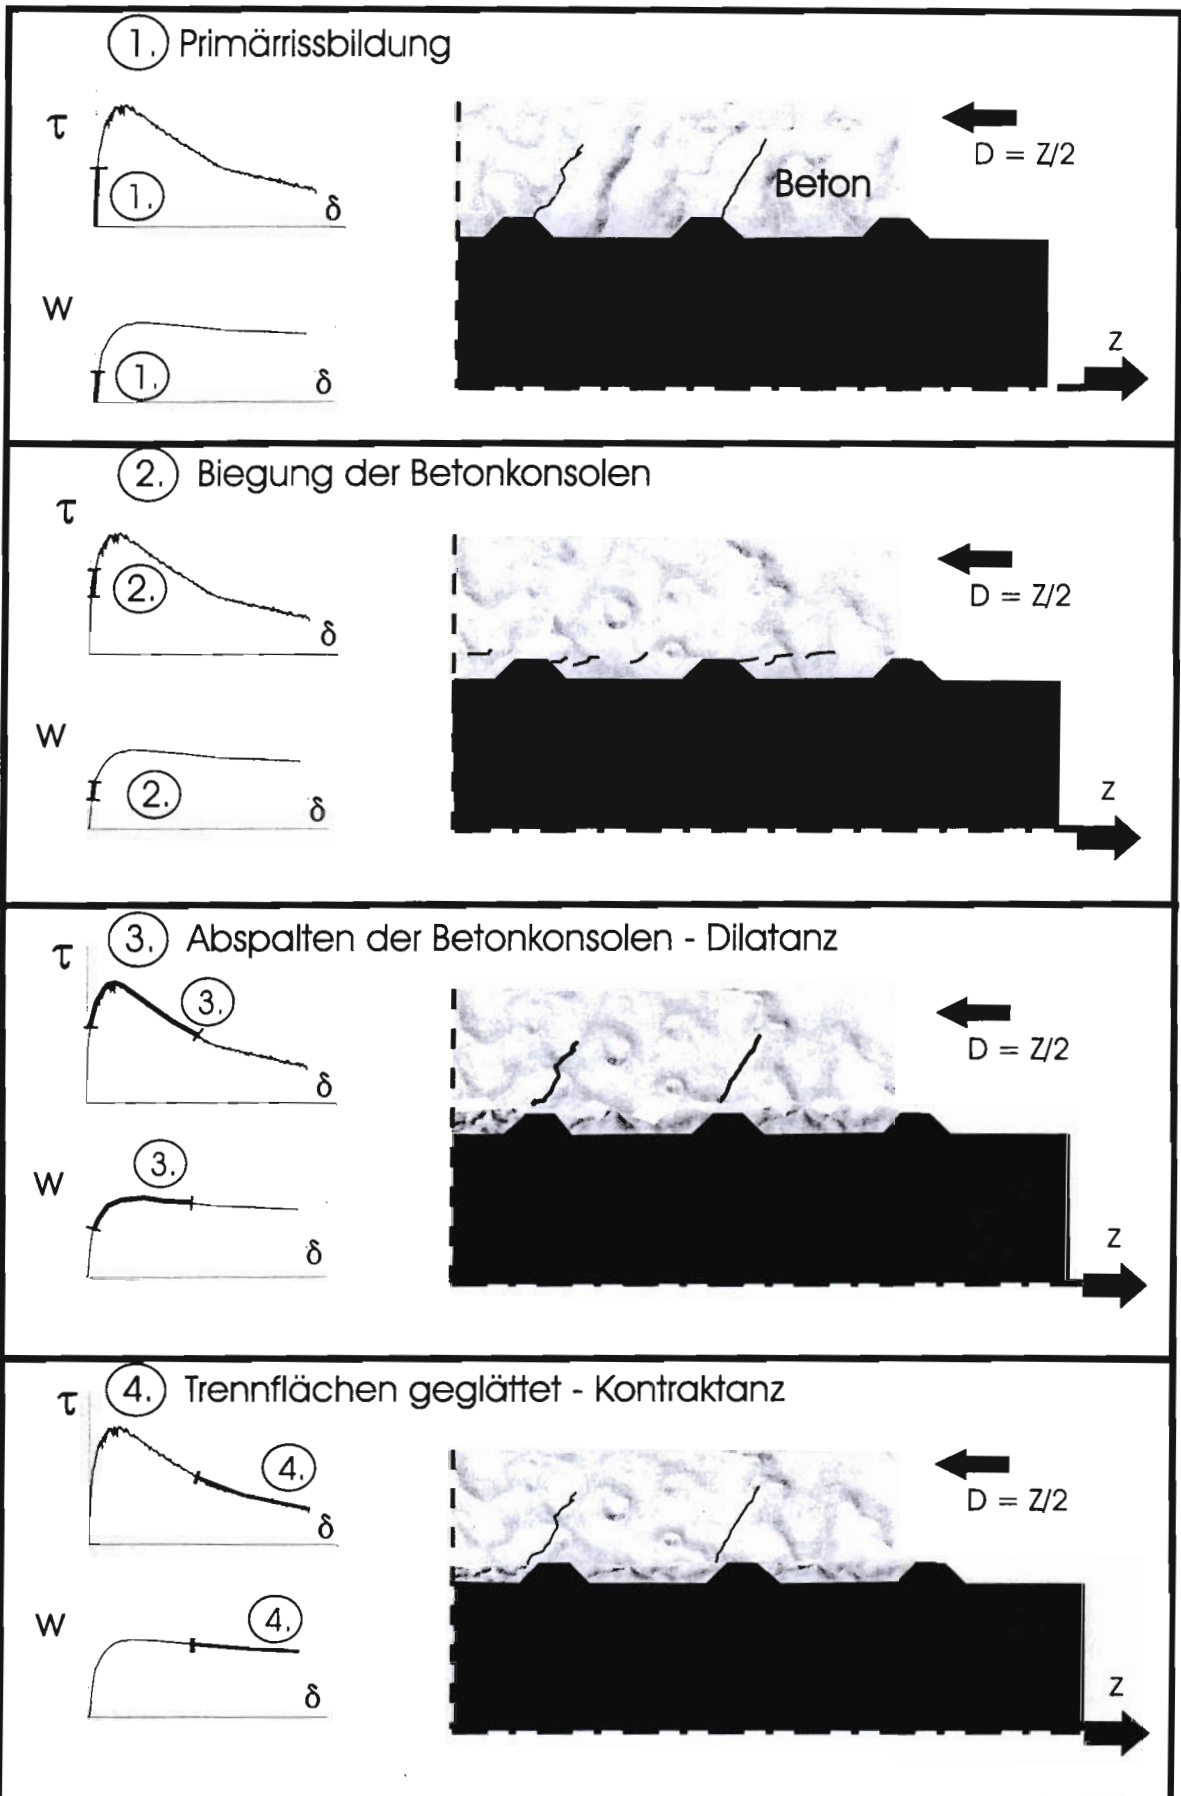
Verbundmechanismus ohne voreingestellte Risse parallel zum Betonstahl.
